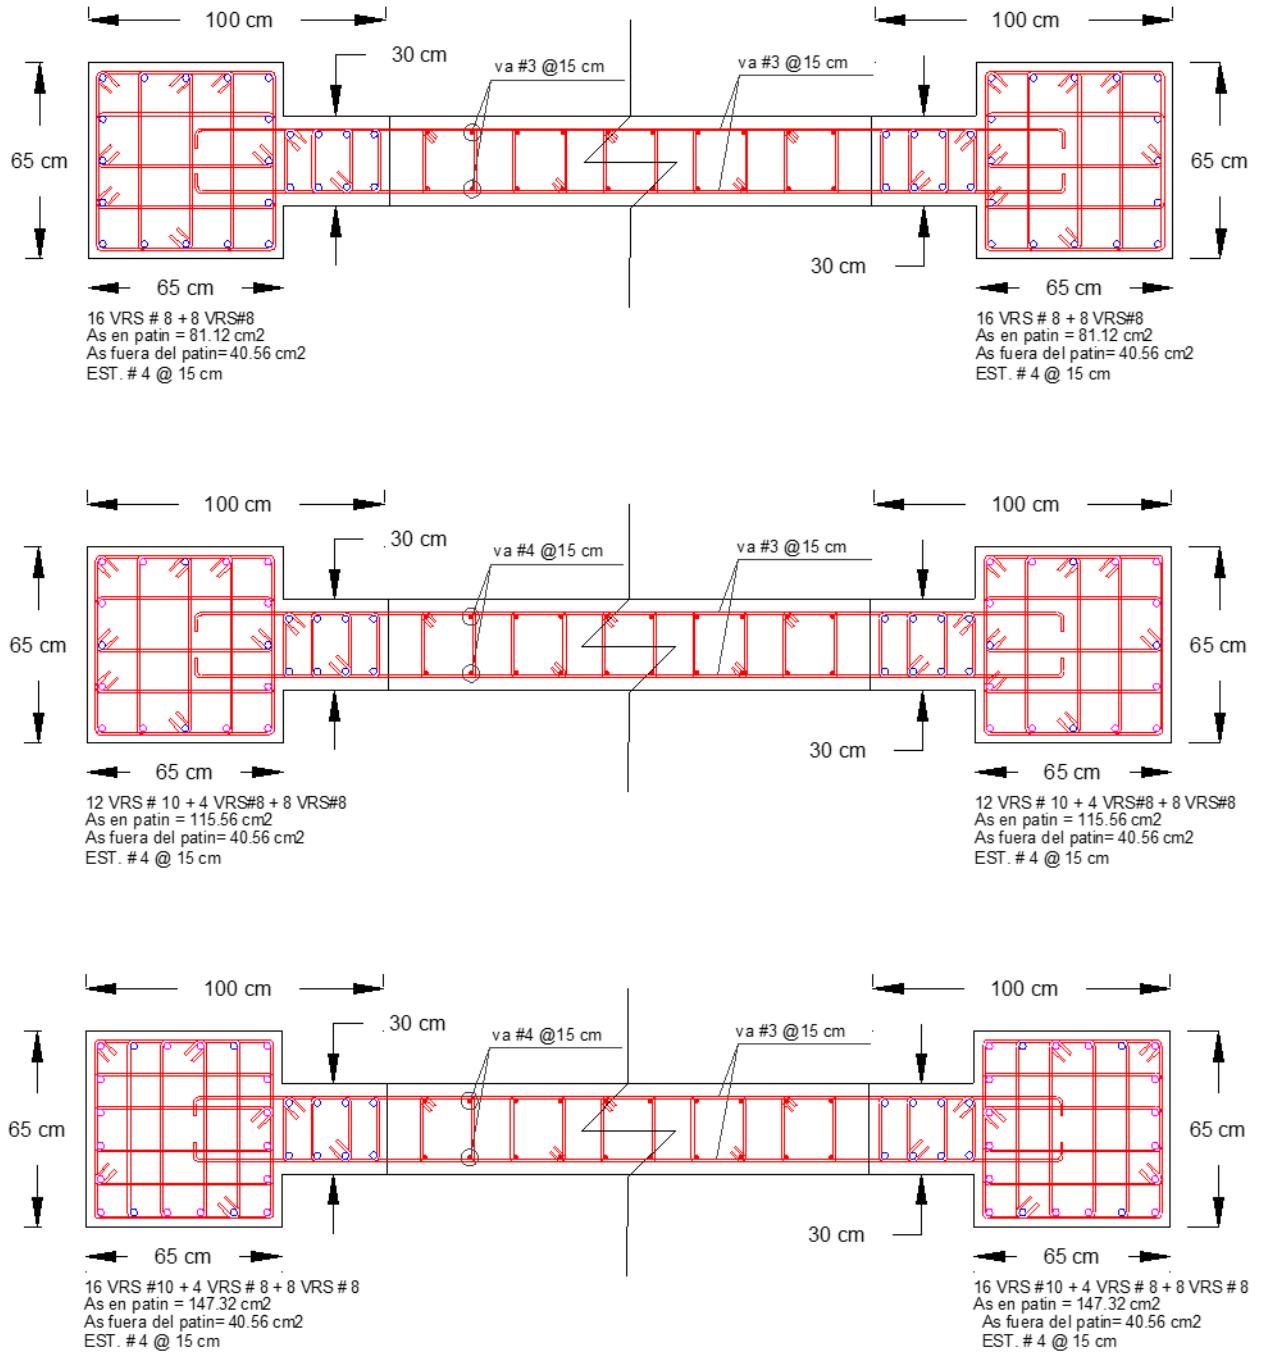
Detallado del refuerzo en muros obtenido en el diseño por desplazamientos.
